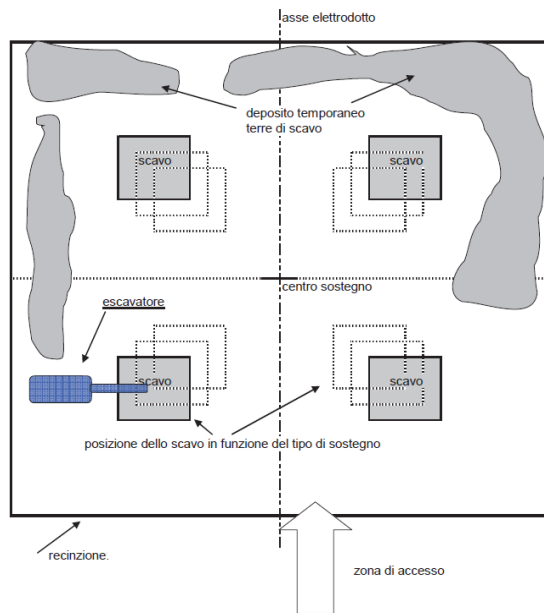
Planimetria tipologica del microcantiere nella fase di scavo delle fondazioni
